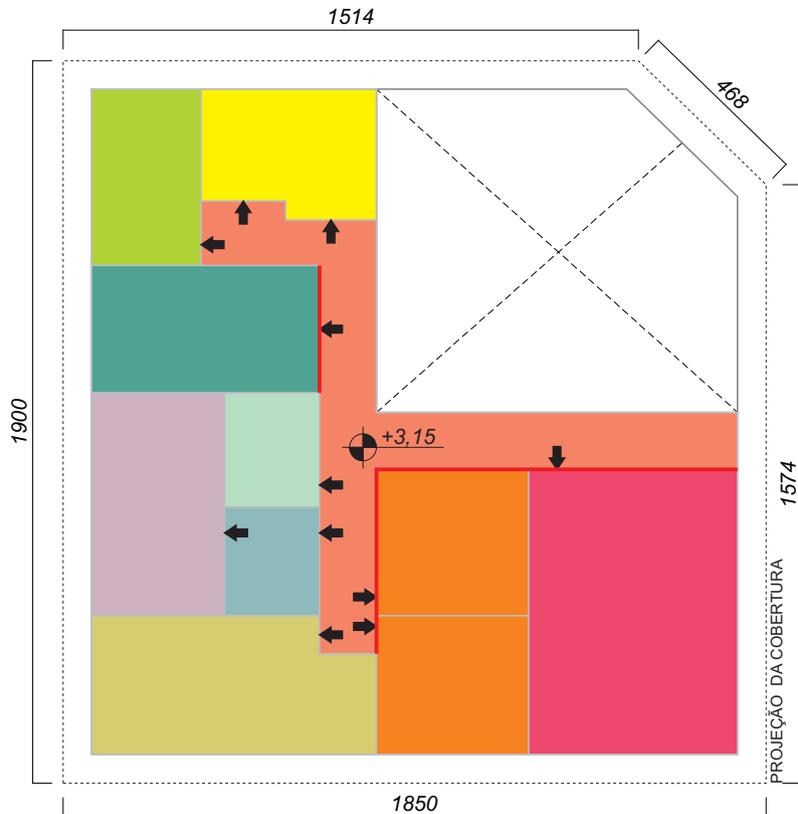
Planta baixa setorizada, 1º pavimento – Bloco de Adoção.
